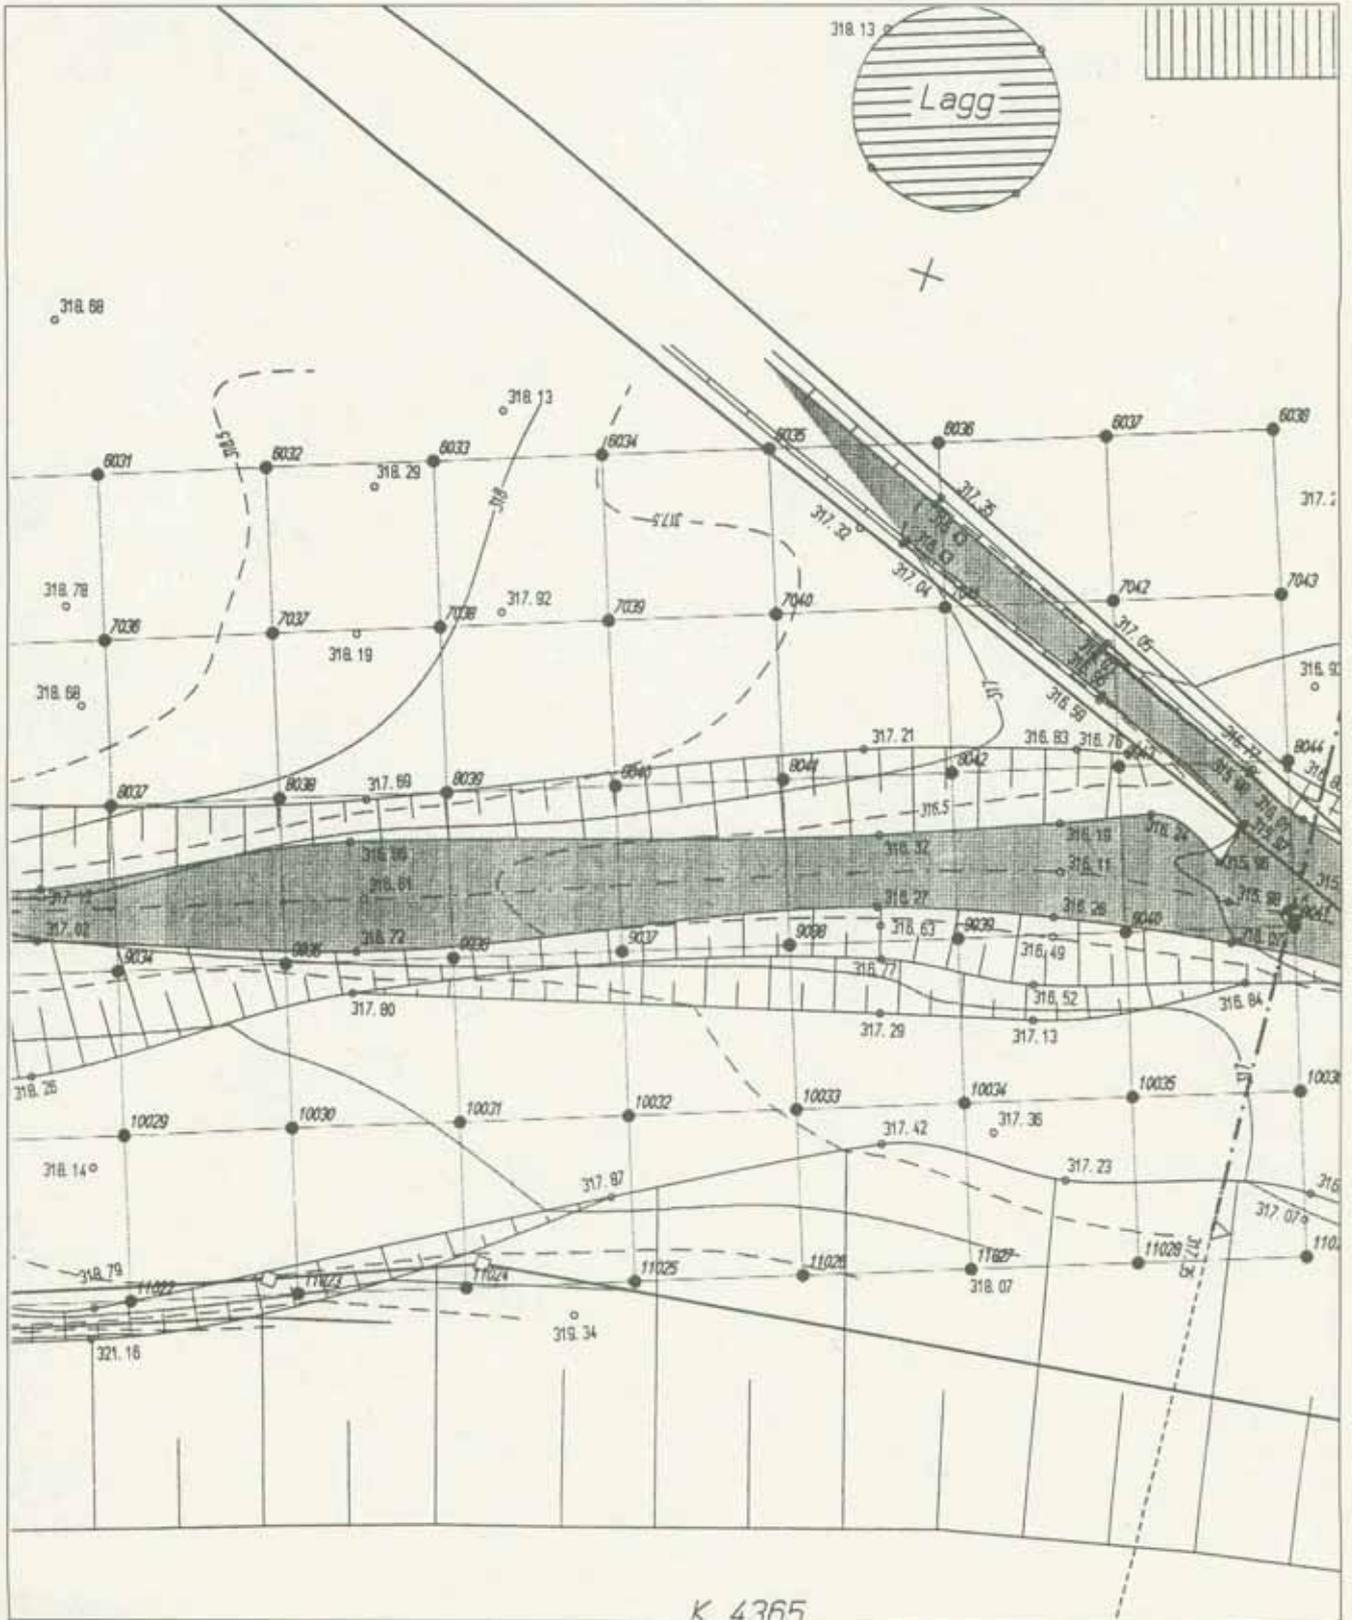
Beispiel Ausschnitt aus einem Bestandslageplan mit Untersuchungsnetz.
